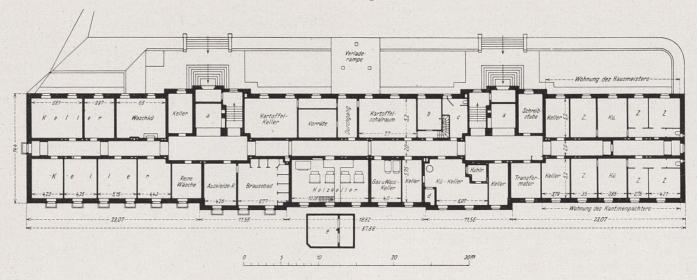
Kellergeschoß. Abb. 2 bis 5. Barmen. Bereitschaftsgebäude. Grundrisse.
